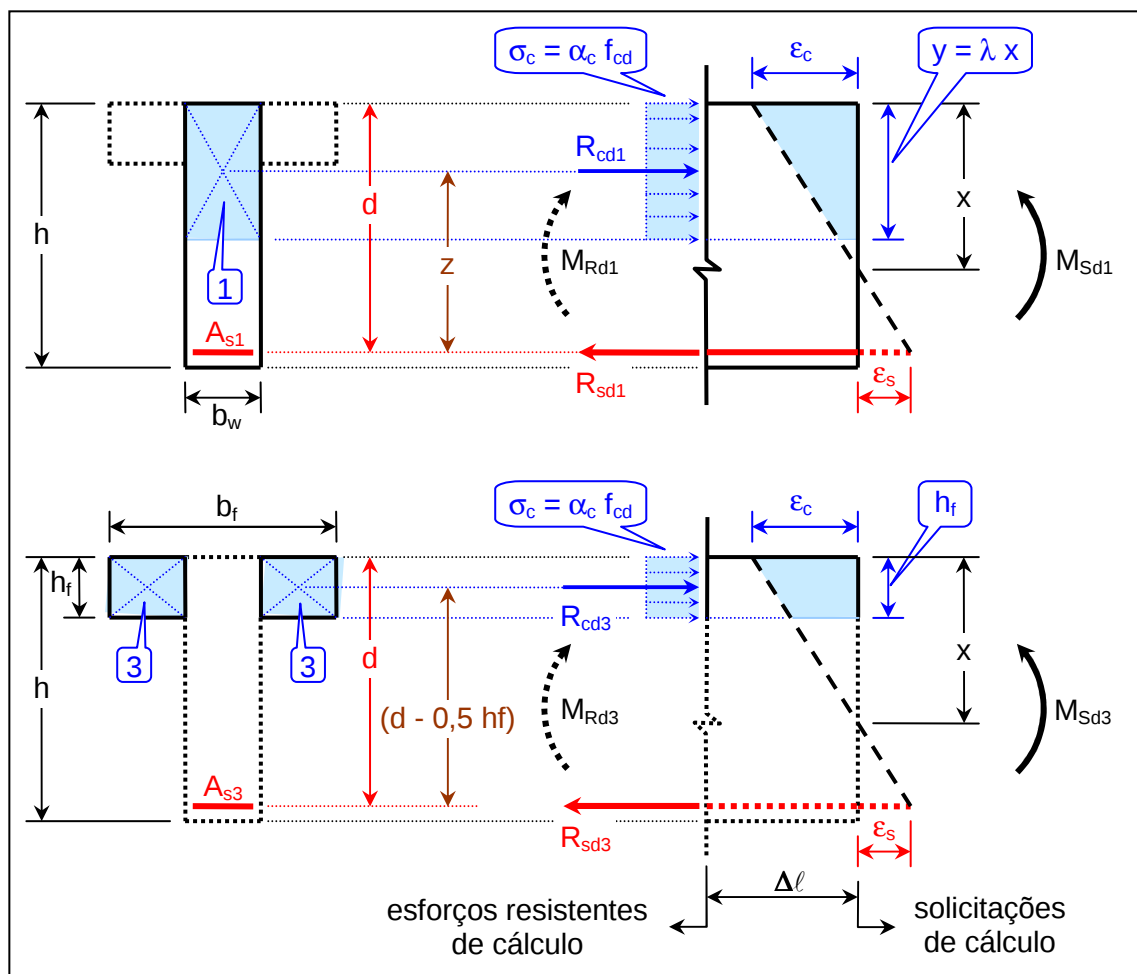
Vigas de seção T sem armadura de compressão - $y > h_f$
